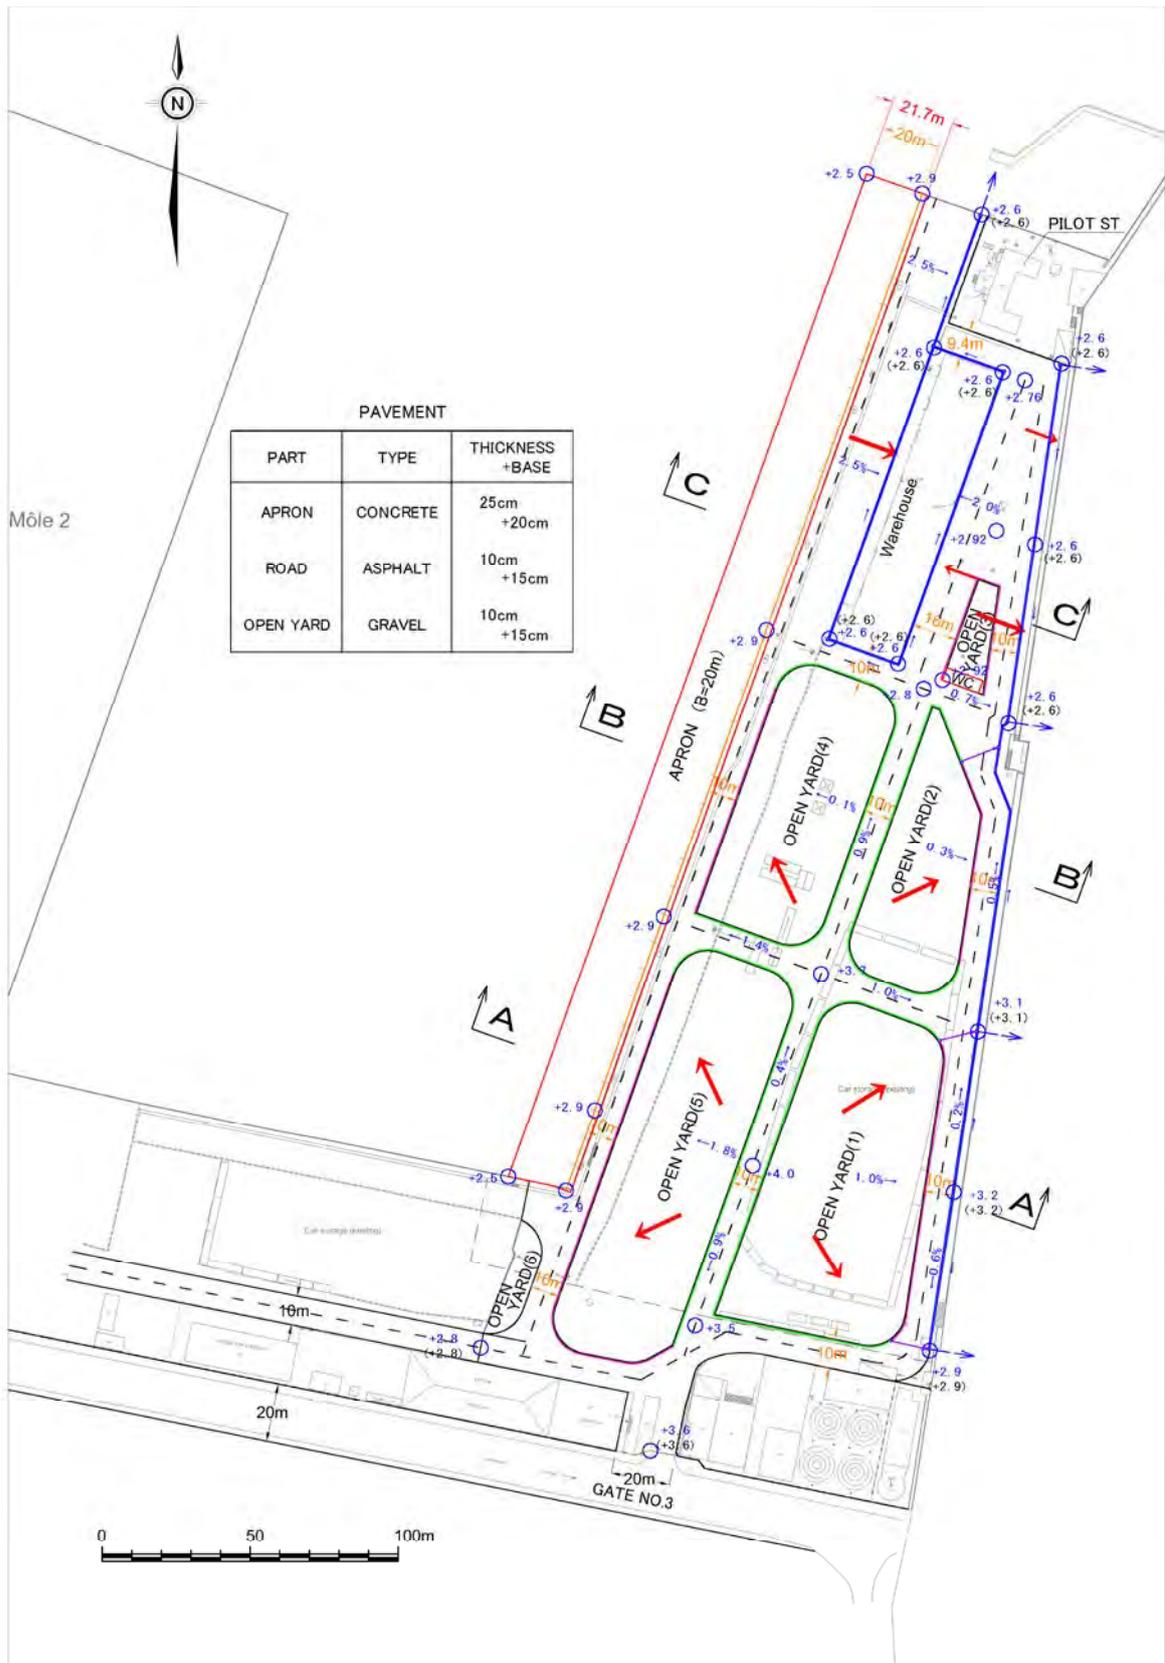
道路、ヤード、排水計画の平面図及び舗装の仕様
